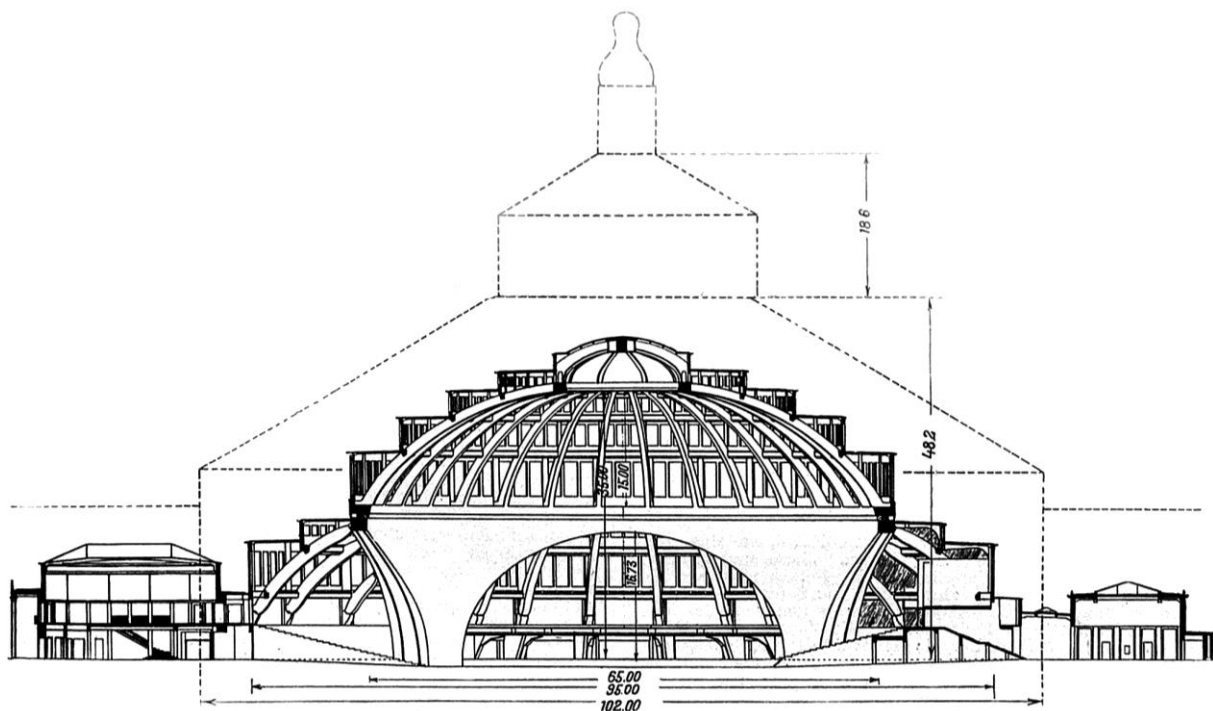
Abmessungen der Jahrhunderthalle im Vergleich zur Wiener Rotunde
